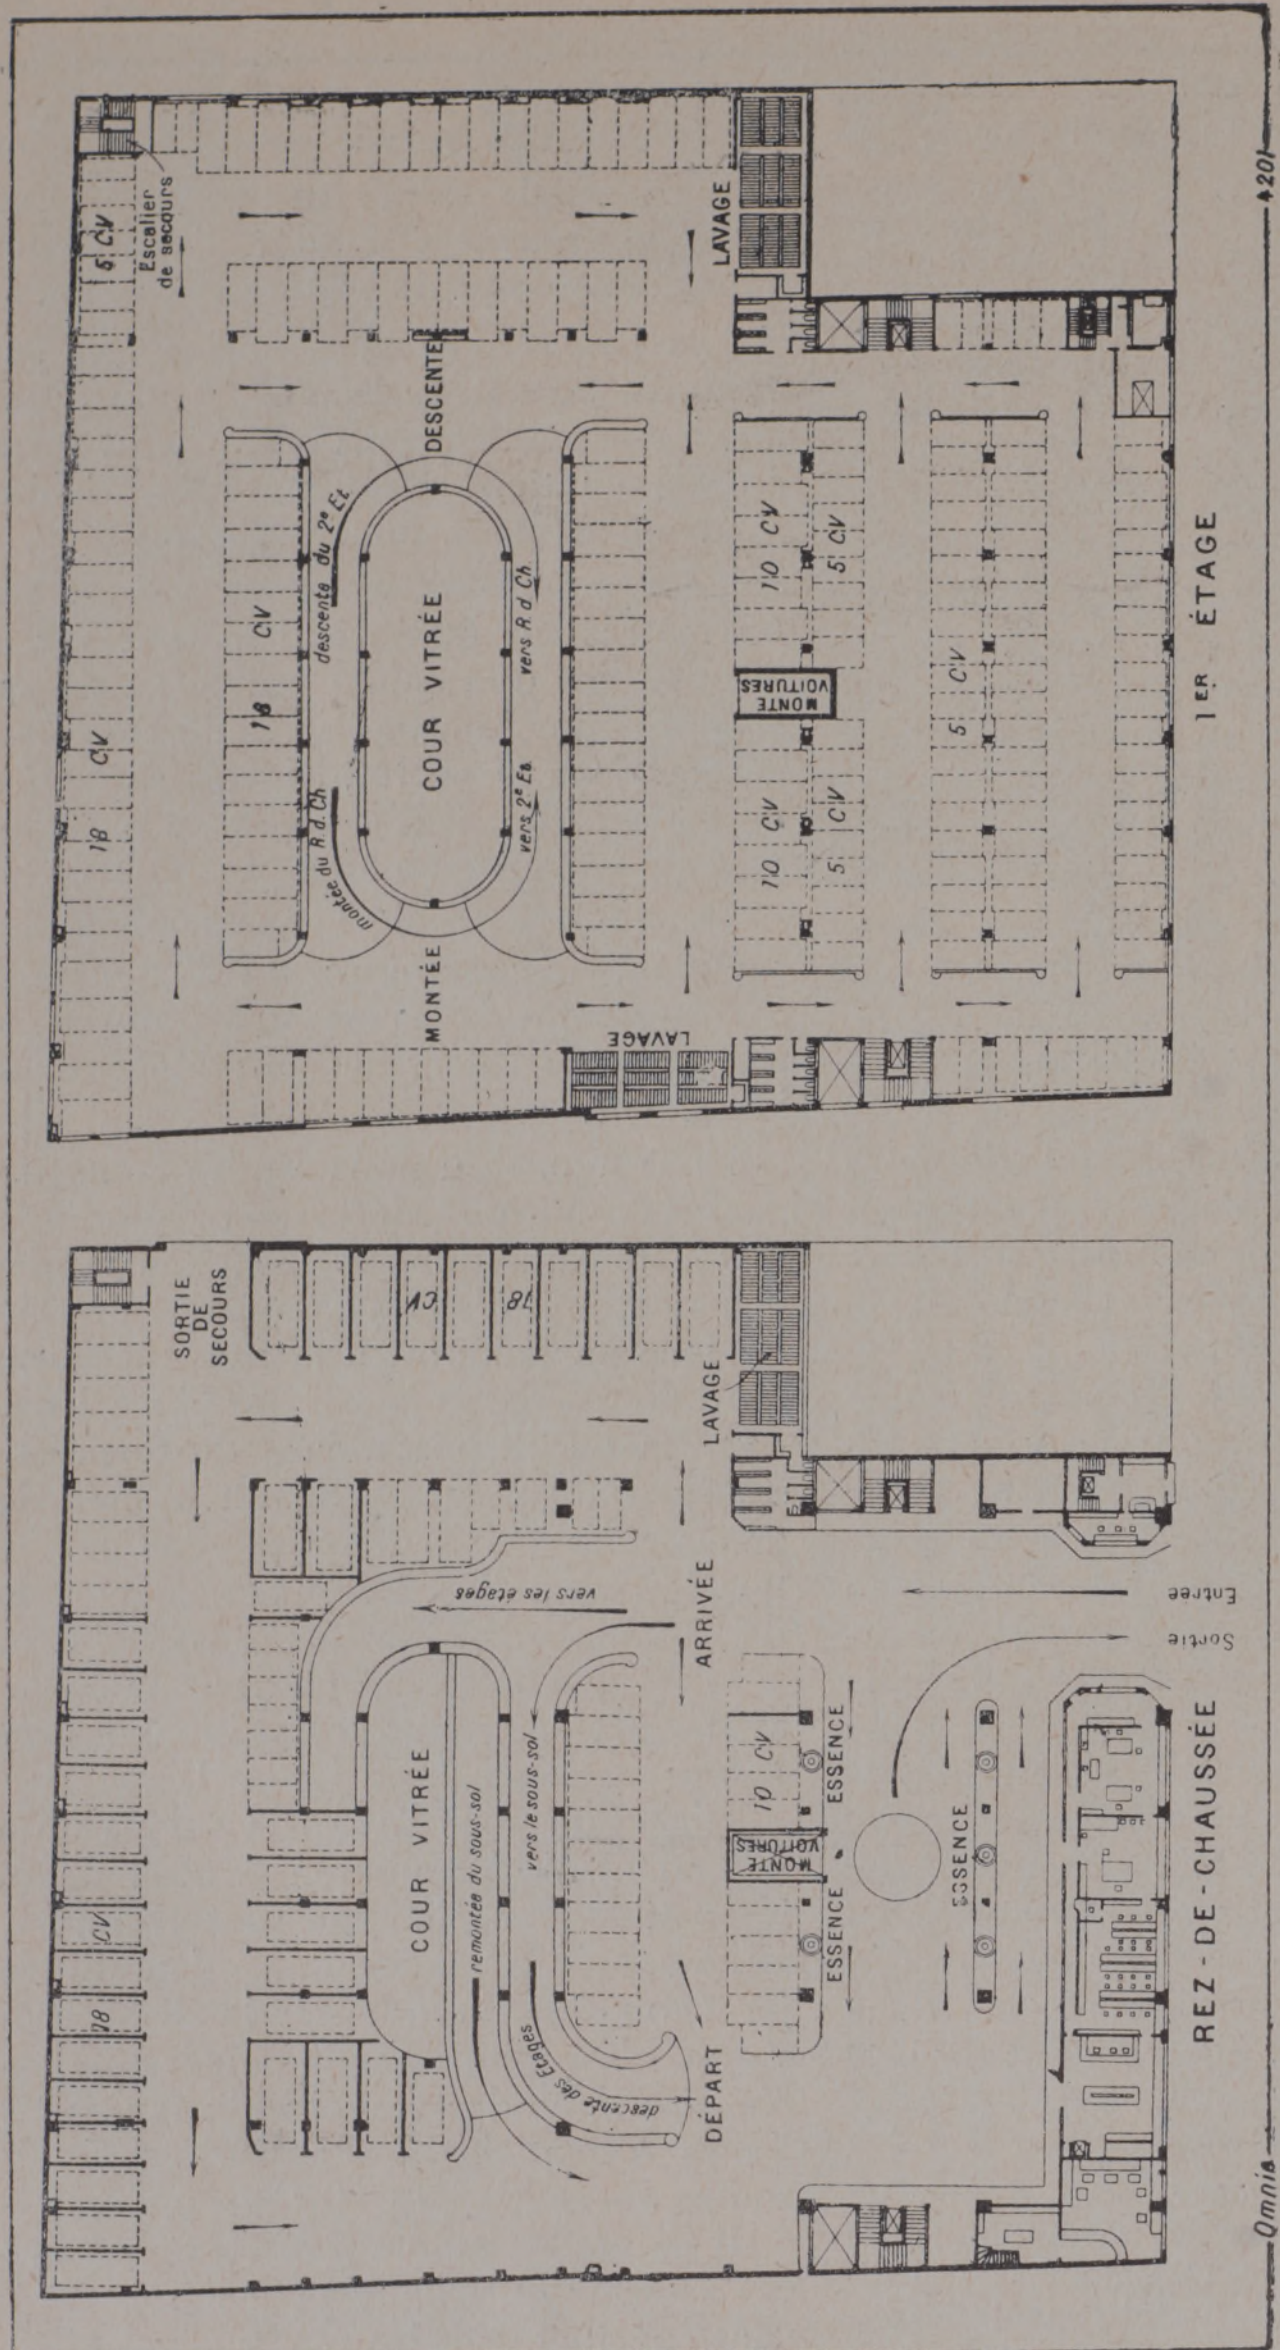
Fig. II. — PLAN POUR UN GARAGE-TYPE DE 1,200 VOITURES. — *A gauche : plan du rez-de-chaussée. On distingue l'entrée et la sortie des voitures (par une seule porte). la disposition des allées à circulation à sens unique, les rampes montantes et descendantes, les ascenseurs pour les clients placés près de l'entrée, les vestiaires, les bureaux, les postes d'essence, etc. A droite : plan du premier étage. Les voitures sont rangées par catégories : 5 CV, 10 CV, 15 CV et plus. Les rampes montante et descendante aboutissent chacune de part et d'autre de la cour vitrée. Elles permettent la circulation à sens unique dans les allées.
